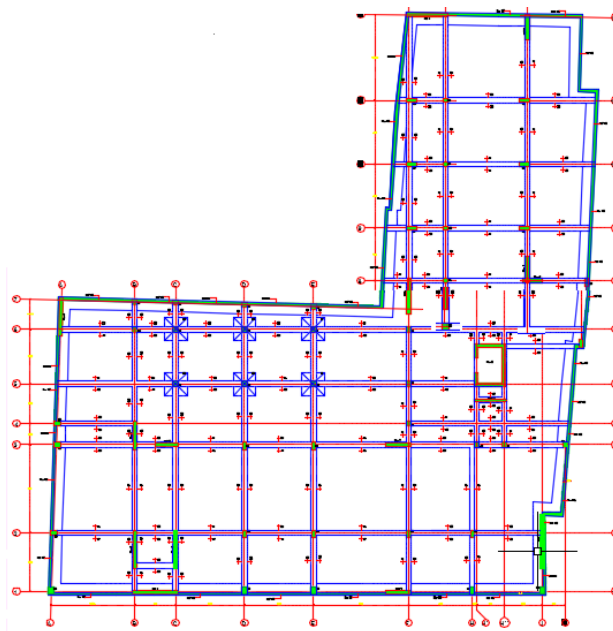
PLANTA VIGAS DE CIMENTACION.
